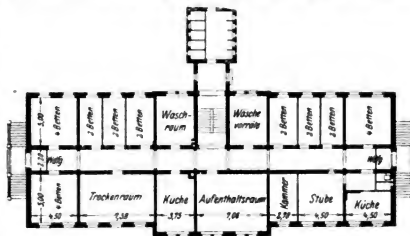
Übernachtungsgebäude in Wustermark. (Erdgeschoß.)
